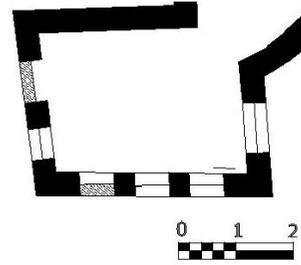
مخطط الطابق الأول من البوابة الشرقية
